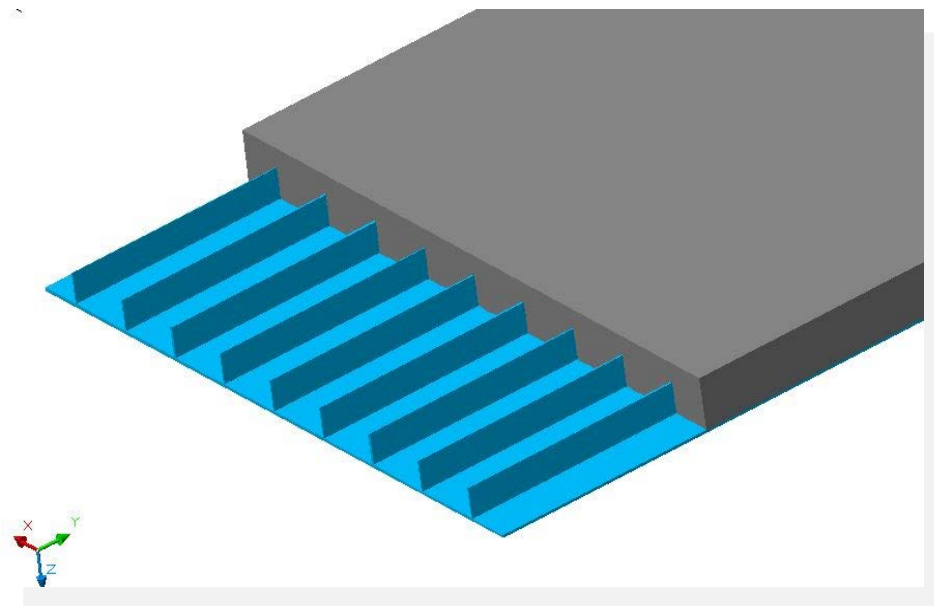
2 – Vedere în spațiu dală cu secțiune mixtă oțel-beton – structura metalică din platbande
